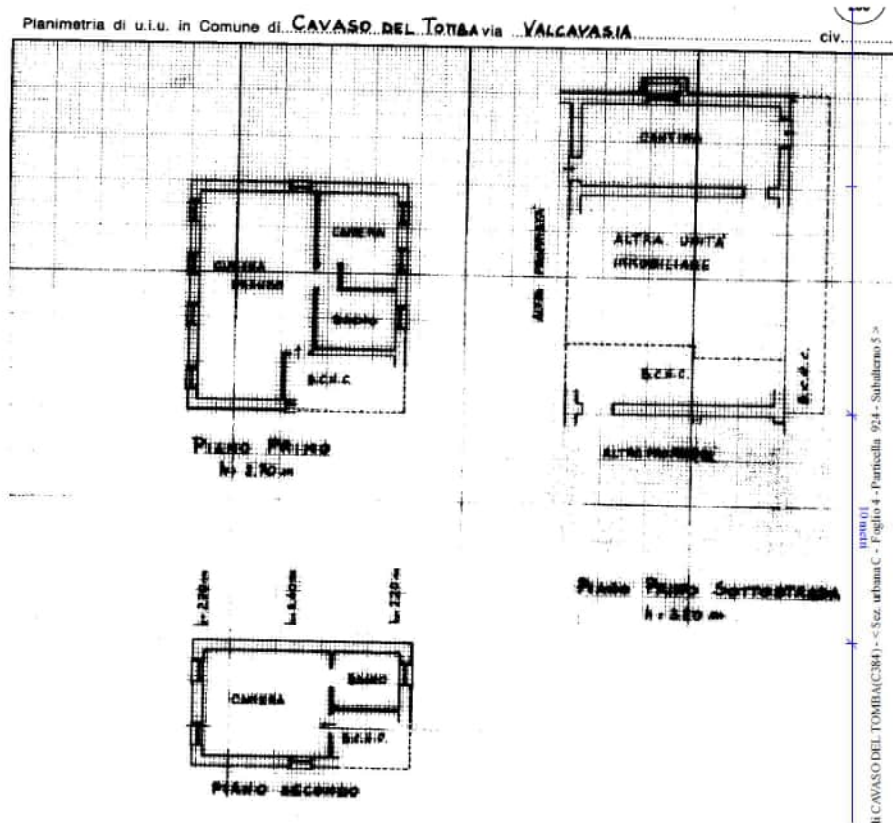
b: Estratto Planimetria catastale Mappale 924, Sub. 5 non in scala
